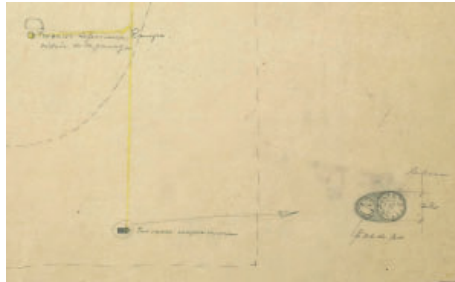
Croquis de saneamiento de planta baja de la *Villa Savoye* a escala 1:50, Atelier LC_PJ. FLC 19573 (pormenor)
